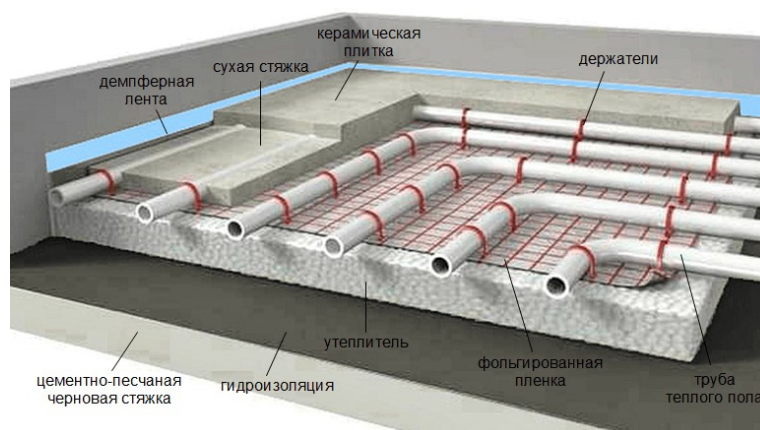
Схема монтажа водяного теплого пола в конструкцию перекрытия
